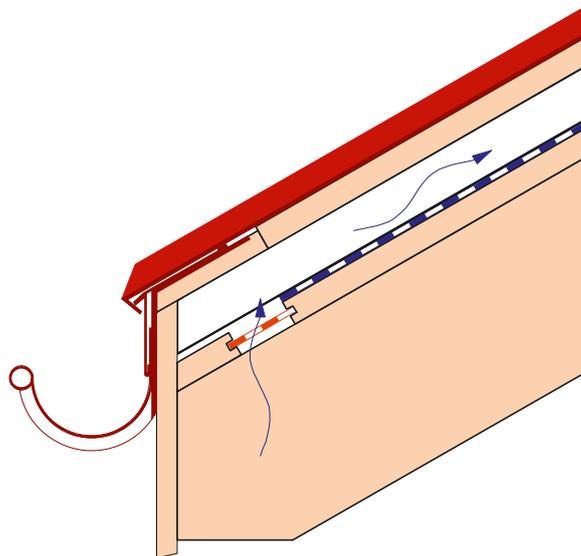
Sottotetto con evacuazione dell'acqua tramite la tettoia
